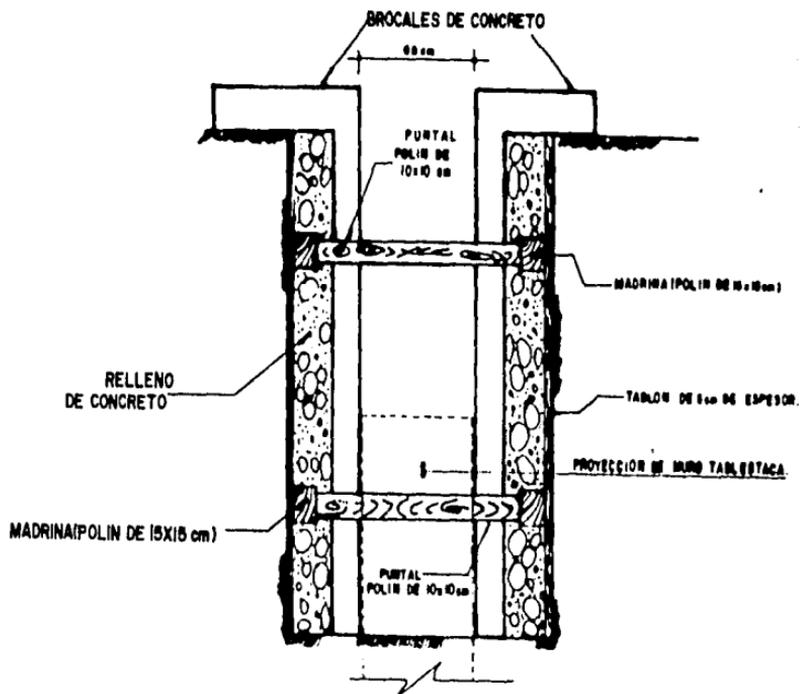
BROCALES COLADOS EN EL LUGAR.
